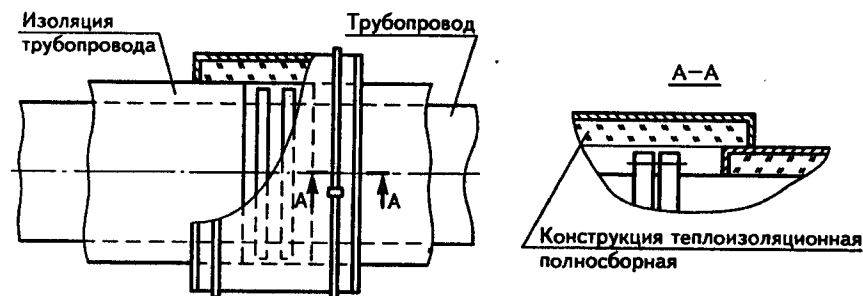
Тепловая изоляция фланцевого соединения конструкцией теплоизоляционной полносборной с теплоизоляционным слоем из цилиндров
